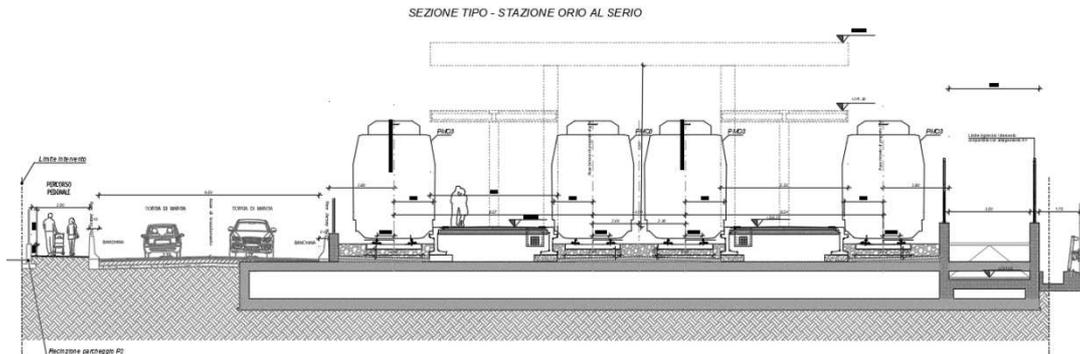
Sezione tipo in Stazione “Orio al Serio”
